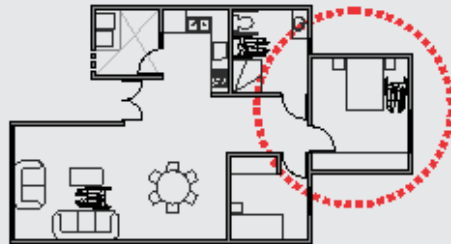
Plano de dimensionamiento y distribución de alternativa de vivienda propuesta.
